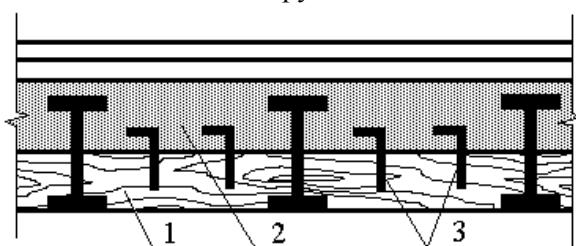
Монолитное железобетонное перекрытие с сохранением существующих деревянных перекрытий
